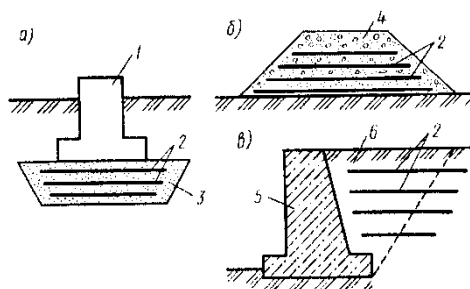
Армирование грунта в искусственном основании фундамента (а), при устройстве насыпи (б), при воздействии засыпок (в):
